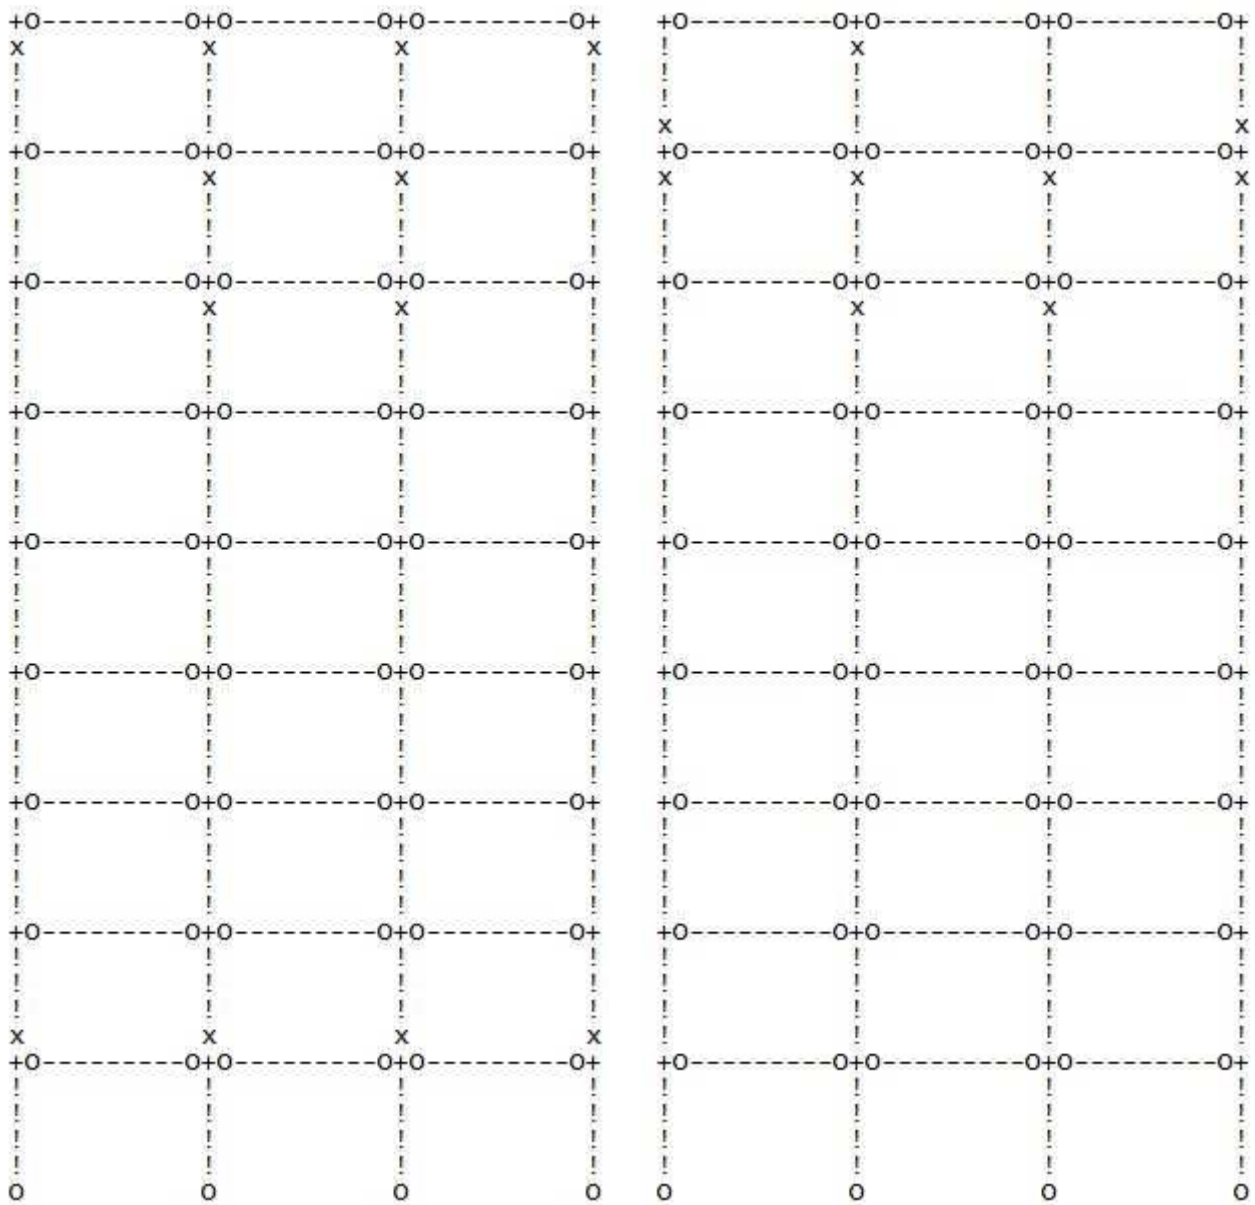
Mecanismo de colapso “columna fuerte-viga débil”. Tipo de pórtico 1 y 2
